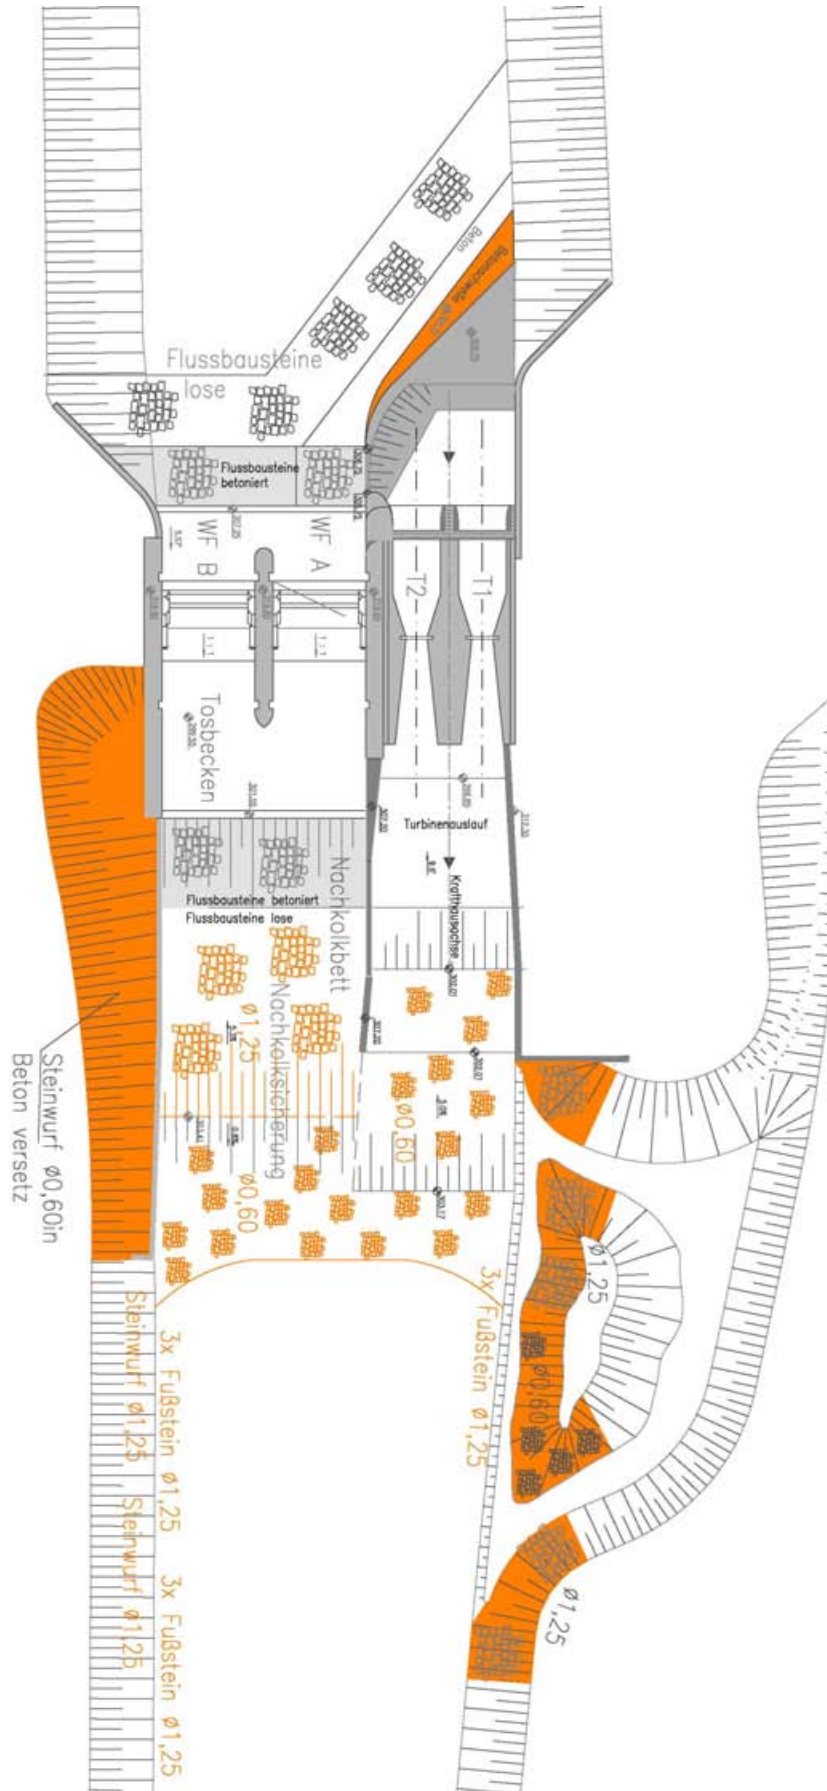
Planliche Darstellung der Empfehlungen - Grundriss
